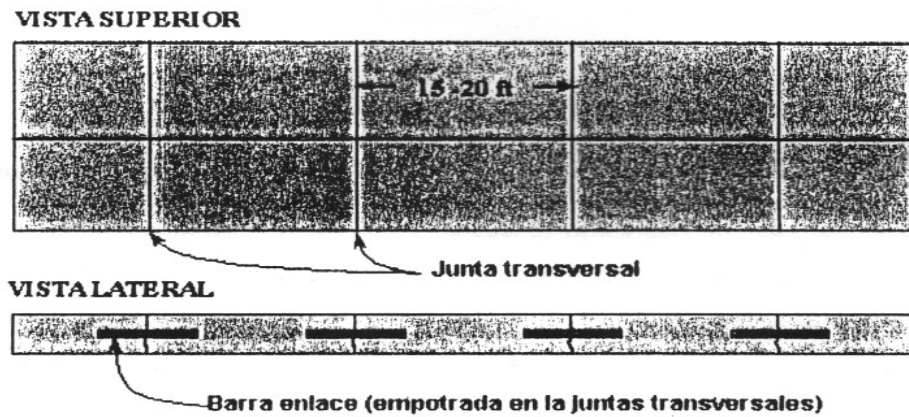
Juntas o pasadores de los pavimentos rígidos.
